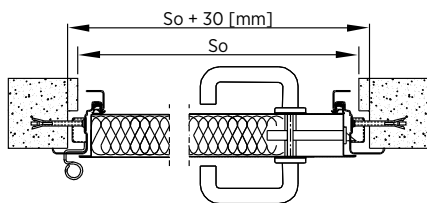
Montage einflügeliger Türen mit Eckzarge an der Mauer – Horizontalschnitt
